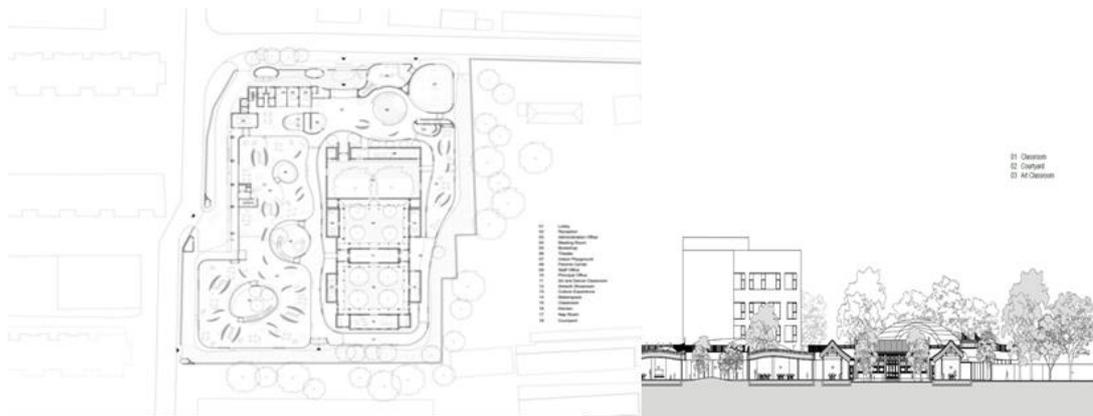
Planta libre del jardín infantil yue cheng courtyard (Archdaily.com)
